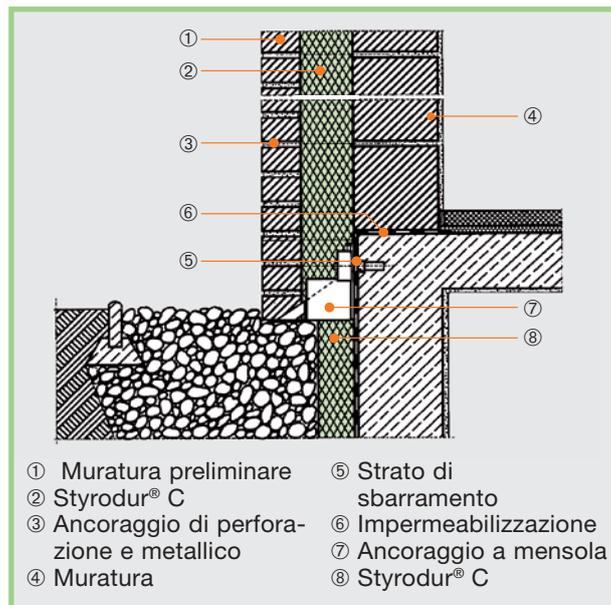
Collegamento dell'isolamento perimetrale alla muratura con isolamento in intercapedine e ancoraggio a mensola.
